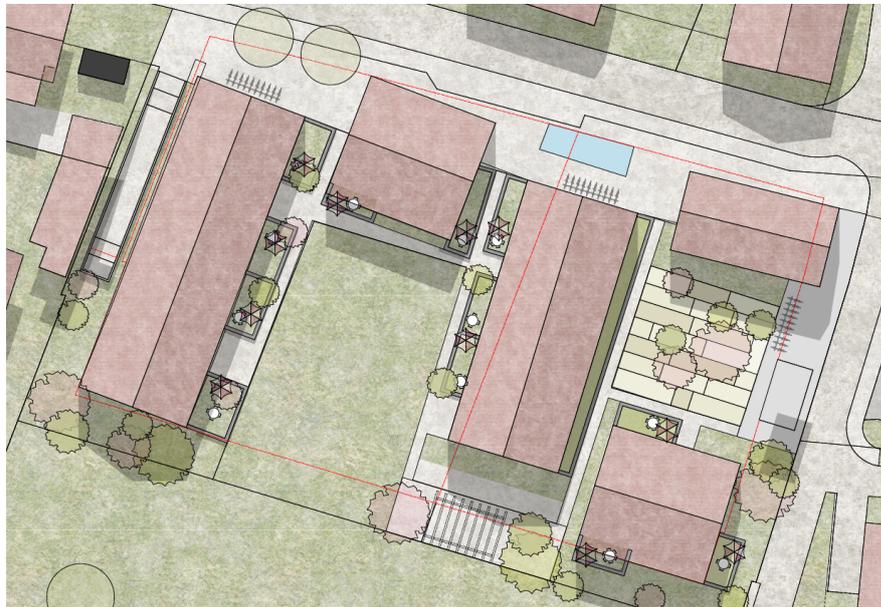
Das Baukonzept sieht eine 3-geschossige Bauweise mit Satteldächern vor
